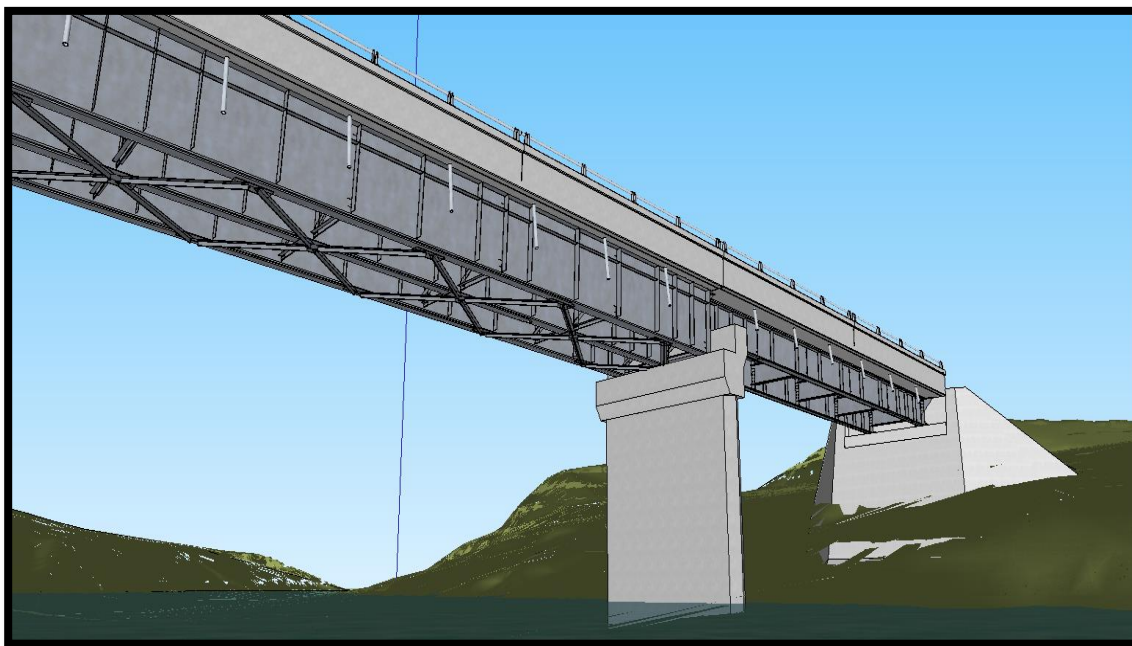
Puente el Tigre, vista de los drenes y pila
